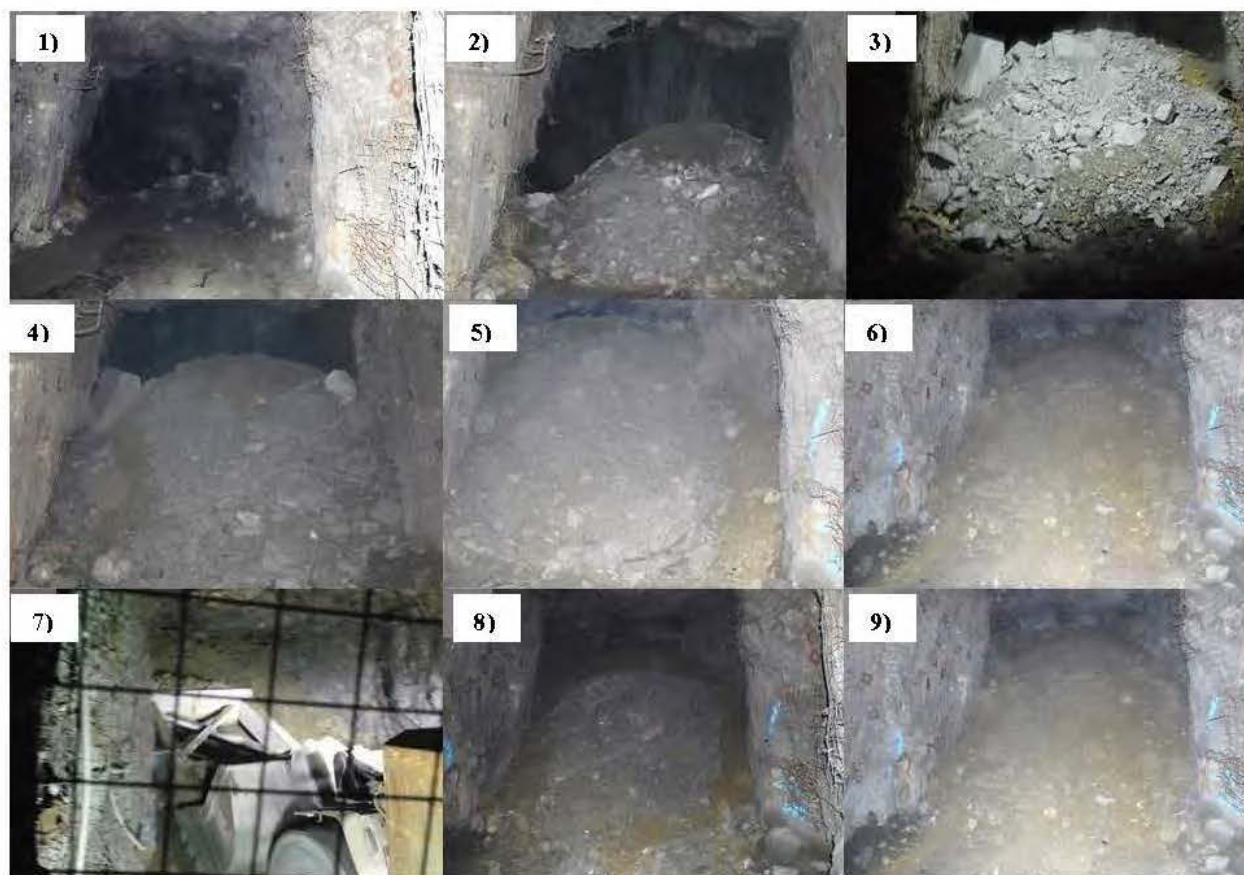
Montage de photos prises d'une barricade de stériles pendant les phases de construction à la mine LaRonde.
